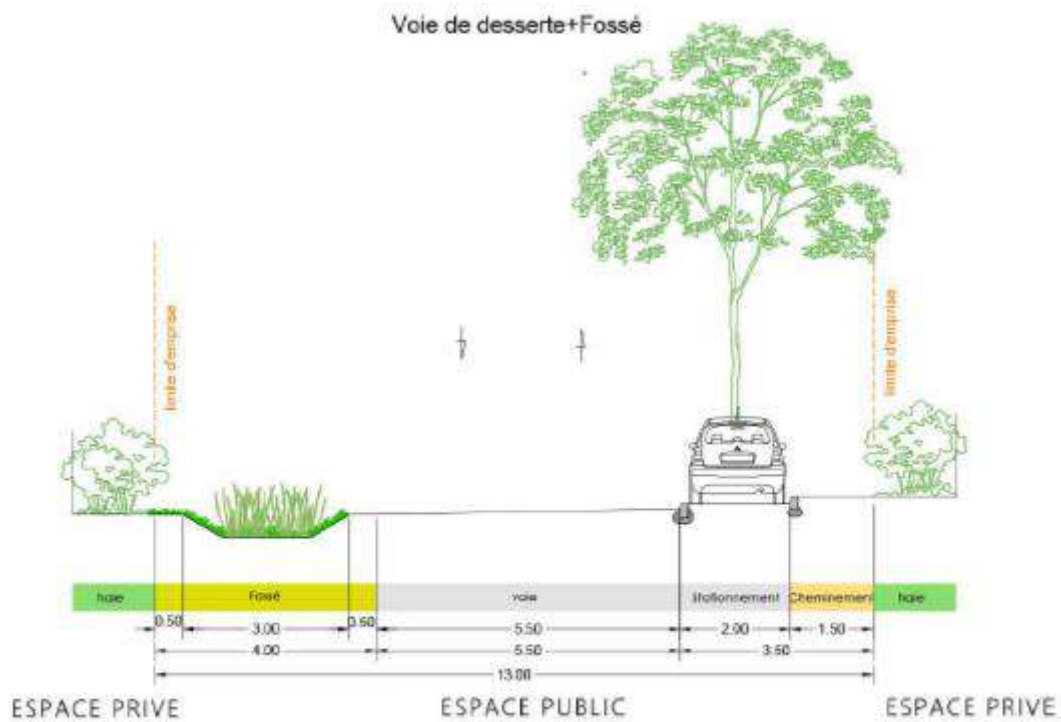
Plan en coupe d'une voie de desserte (Source : VERDI)
